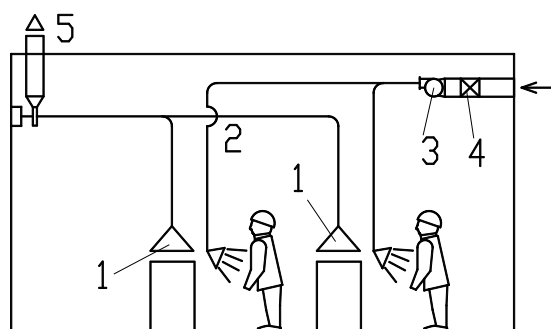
Схема местной вентиляции / Scheme of local ventilation
